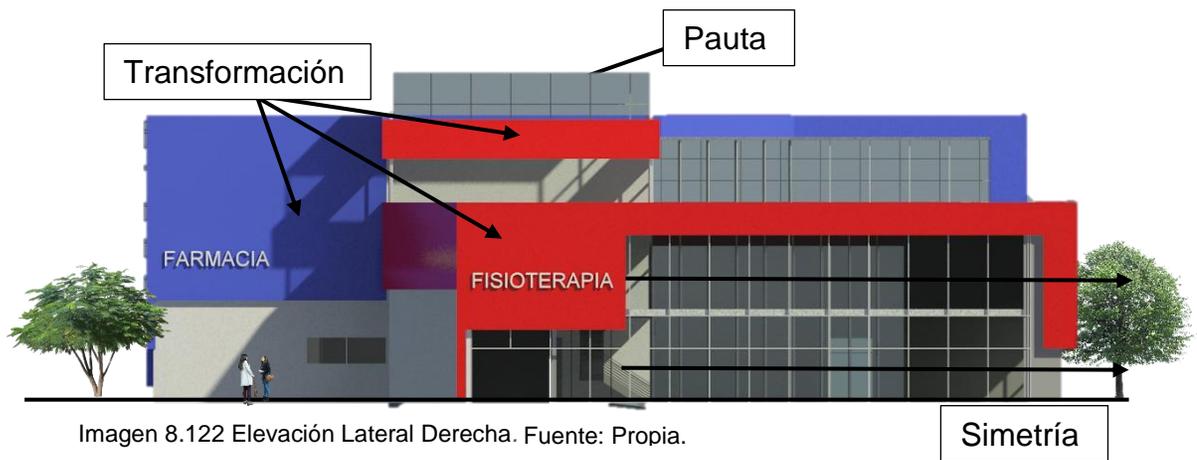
Elevación Lateral Derecha. Fuente: Propia.
